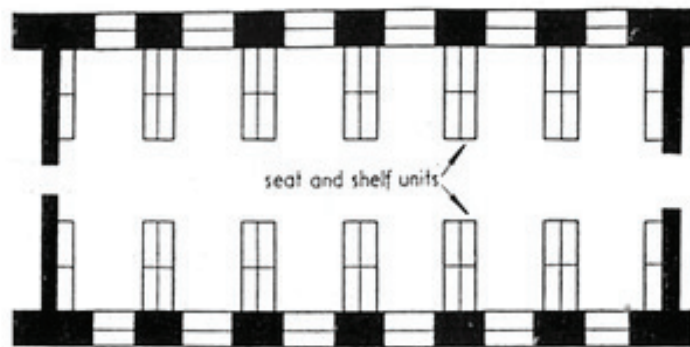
Typischer Grundriss einer Klosterbibliothek
